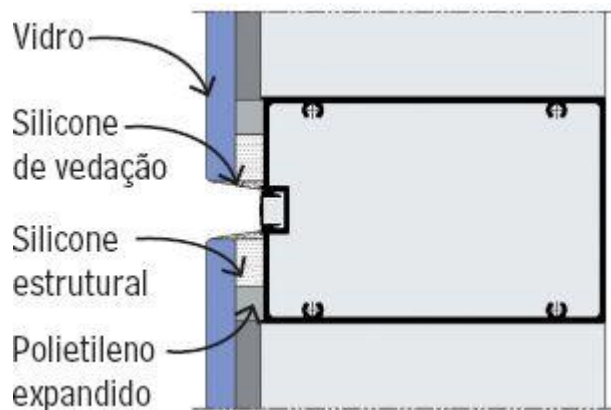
Detalhes do sistema - fixação do vidro ao perfil com silicone estrutural
